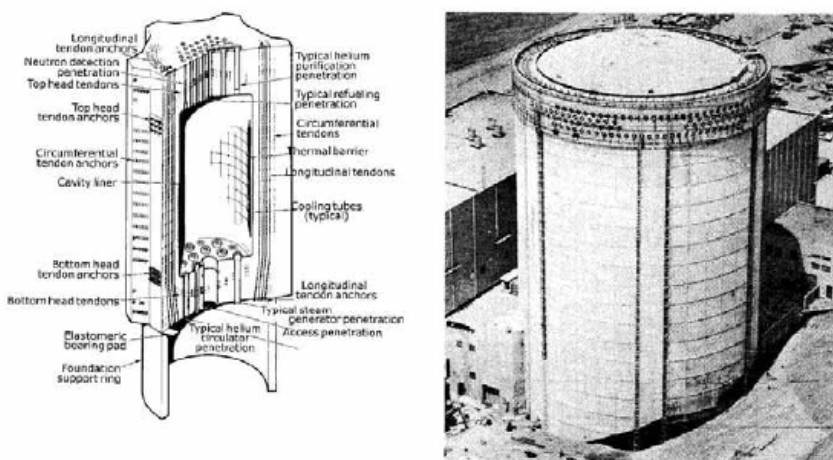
Единый монолитный предварительно напряженный корпус (слева) и двухслойная оболочка ядерного реактора (справа) [10]
